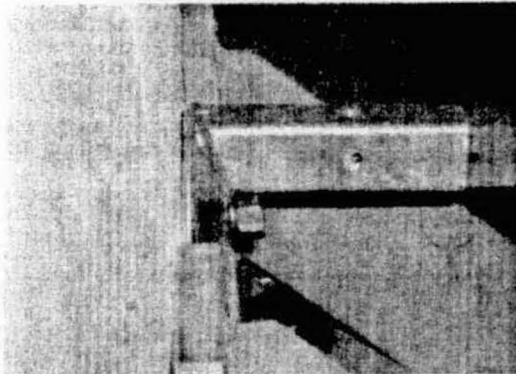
Detailaufnahme bei Belastung mit 1,0 kN nach innen
